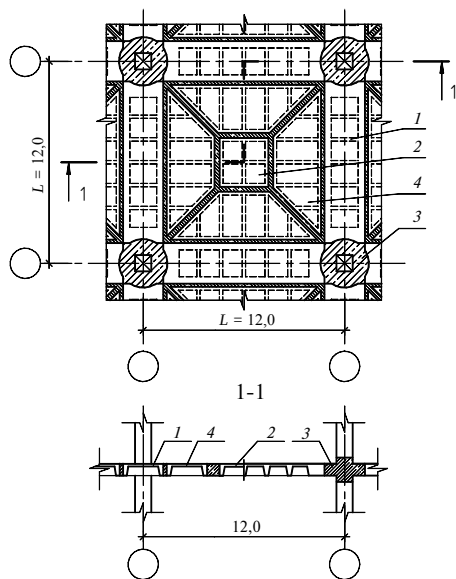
Квадратная ячейка перекрытия с ригелями по контуру.
